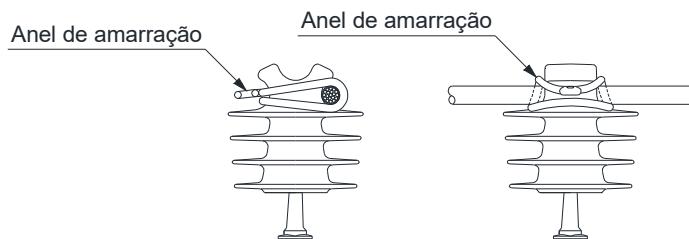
Amarrações e ligações – Amarração lateral do cabo protegido – Anel de amarração
